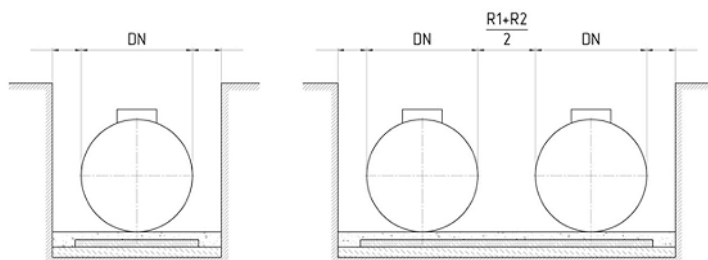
Схема котлована (траншеи) с вертикальной укрепленной стенкой
